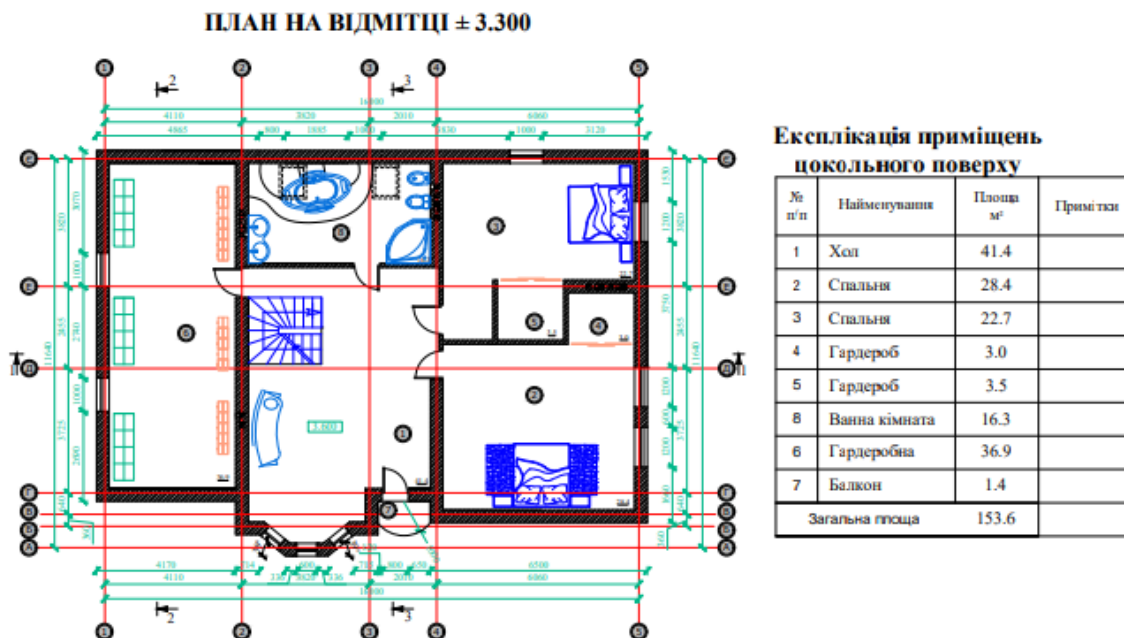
План другого поверху. Хол – 41.4, спальня -28,4, спальня -22.70, гардероб – 3.00, ванна кімната – 6.25, кладова – 2.59, гардеробна – 36,90, балкон – 1,4.
